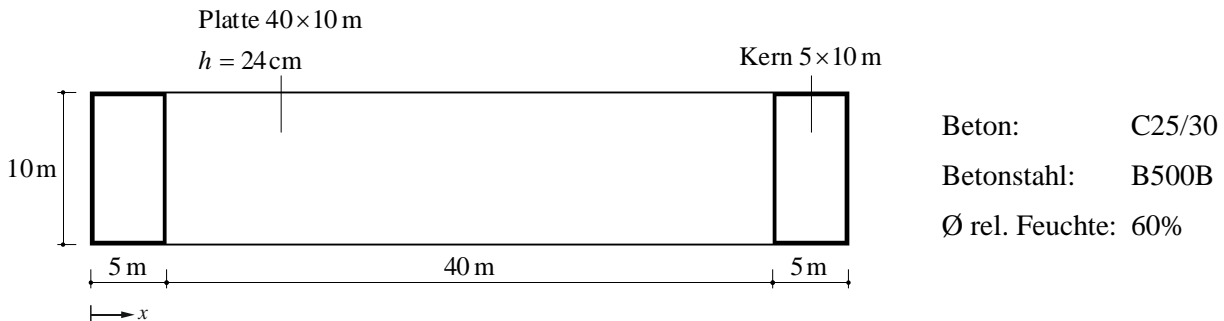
Grundriss, Decke ohne Aussparung
